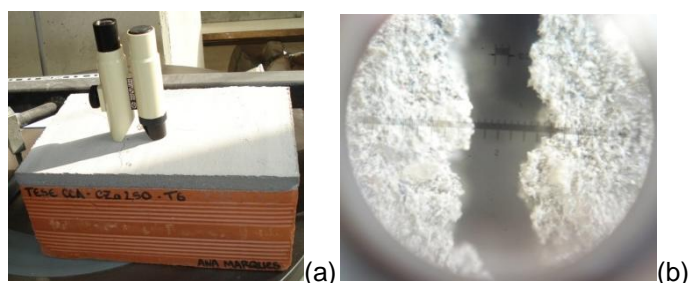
FISSURÓMETRO (A) E VISTA DE UMA FISSURA ATRAVÉS DO FISSURÓMETRO (B)
